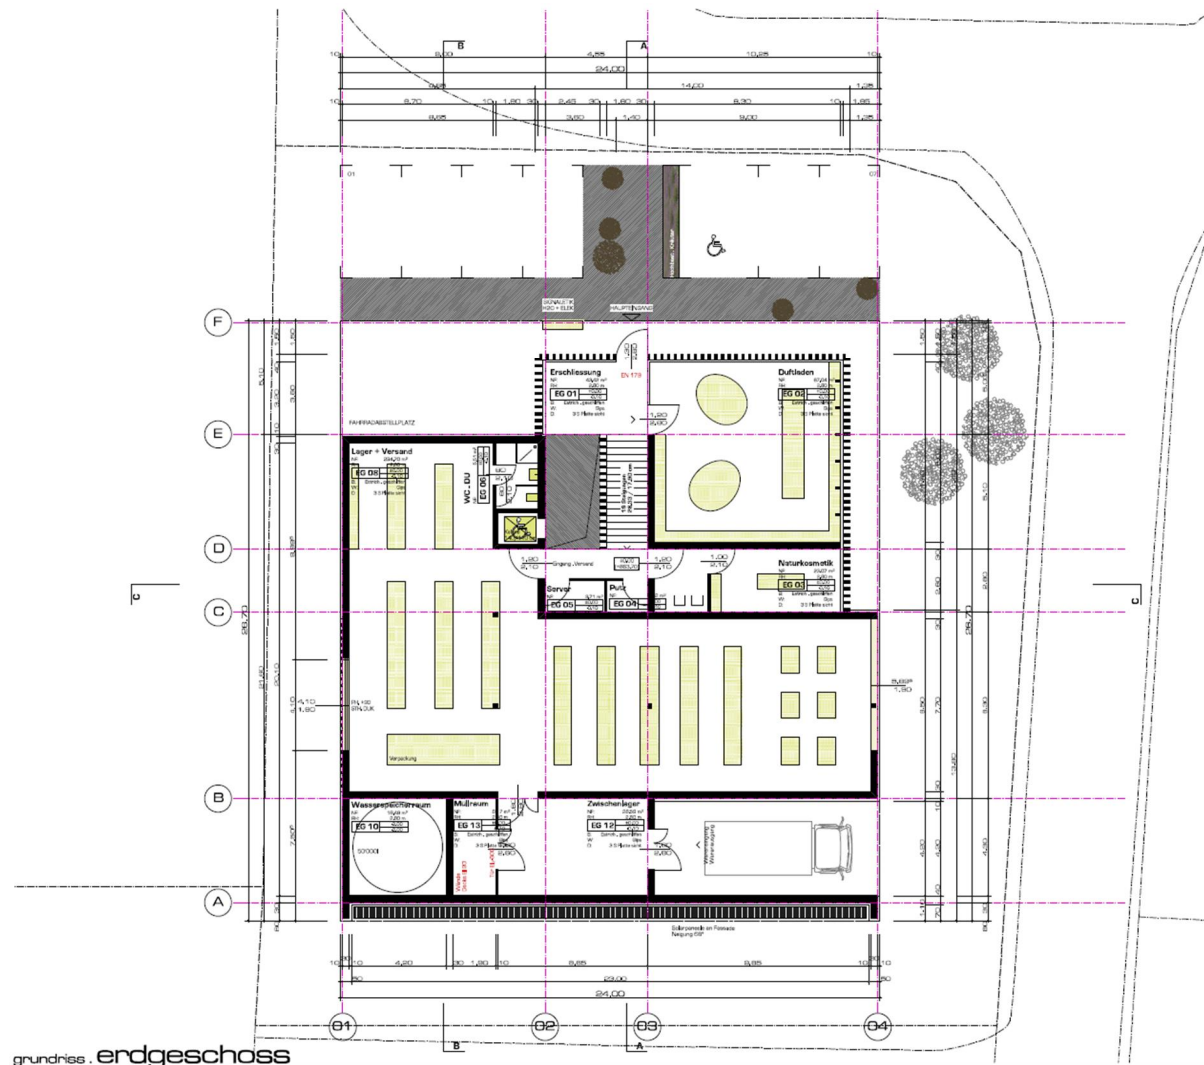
EG Grundriss Einreichung Aromacampus (Ventira Architekten)
